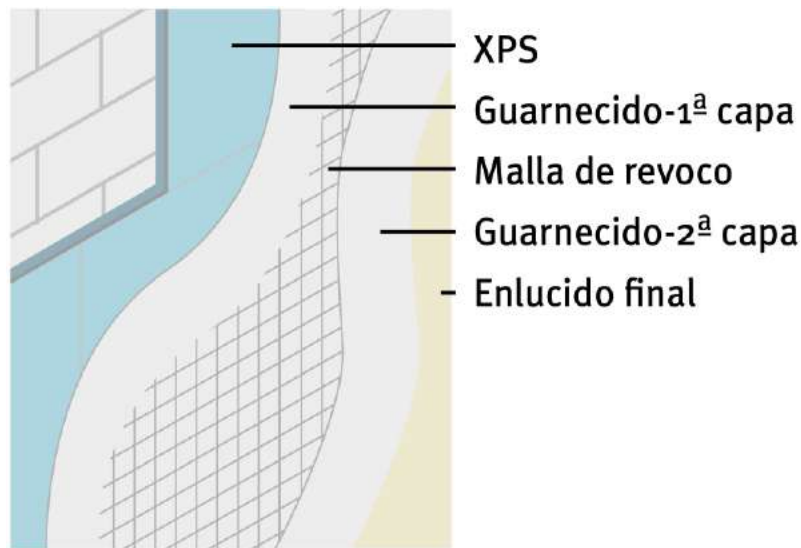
Esquema del sistema de aislamiento térmico de fachadas por el interior
